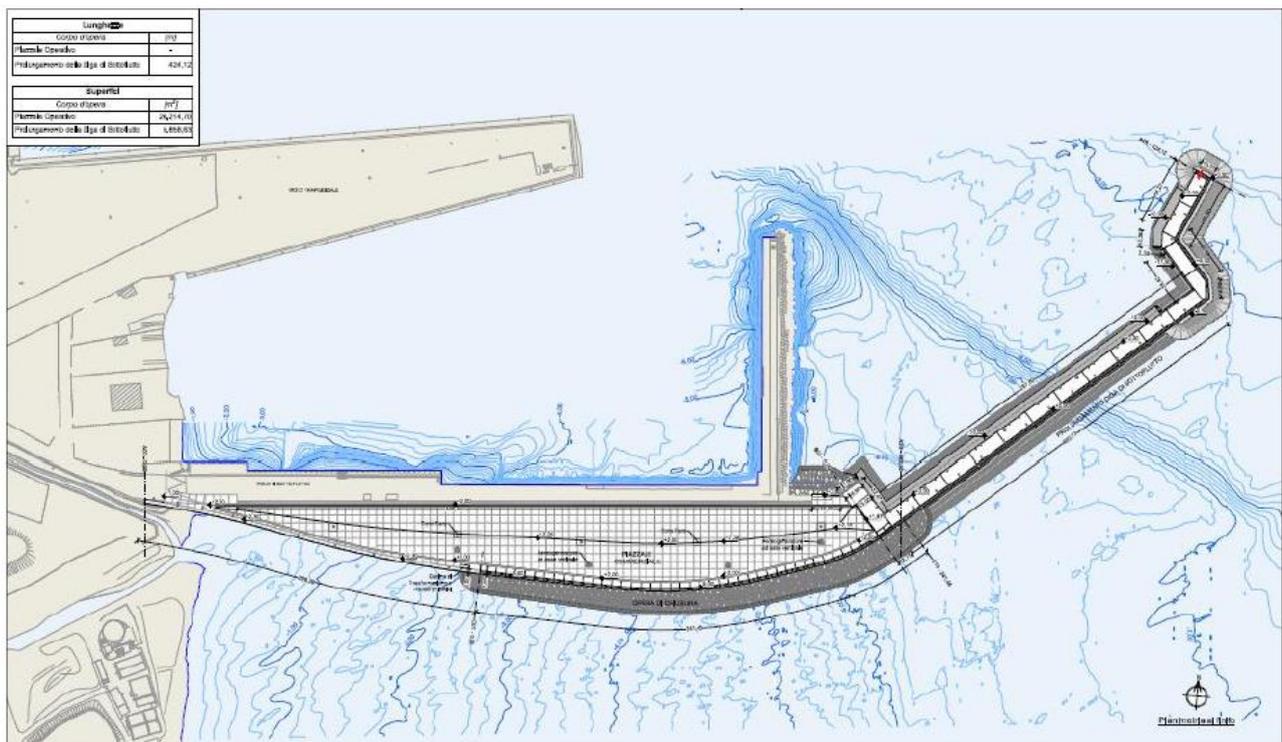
Stralcio della Tavola 5.1 del Progetto Esecutivo: Planimetria generale di progetto
